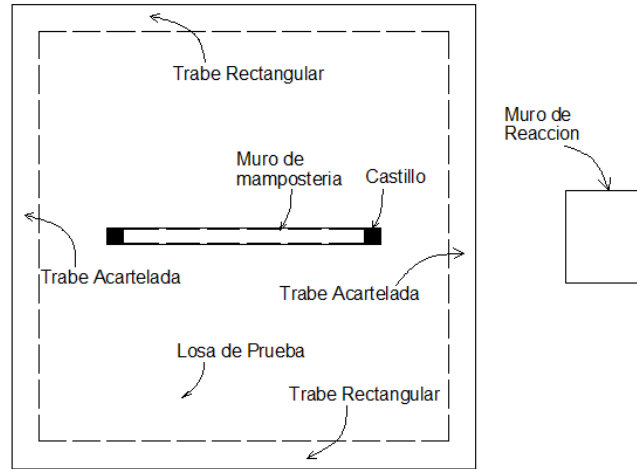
Ubicación de las traveses de apoyo en el espécimen de prueba
